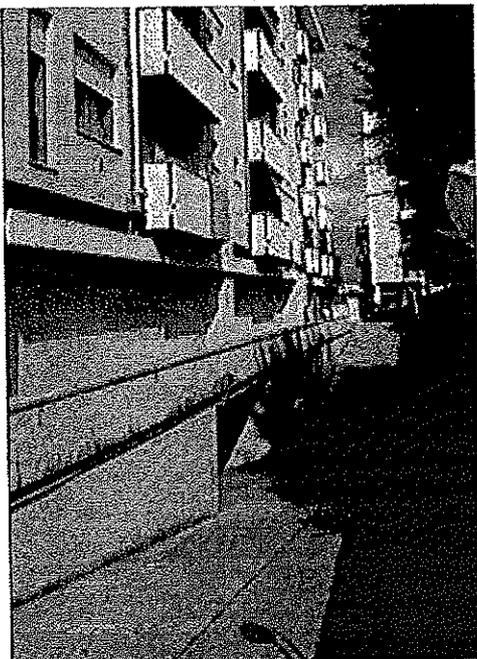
vista del prospetto sud del condominio di cui sono parte le unità in oggetto
